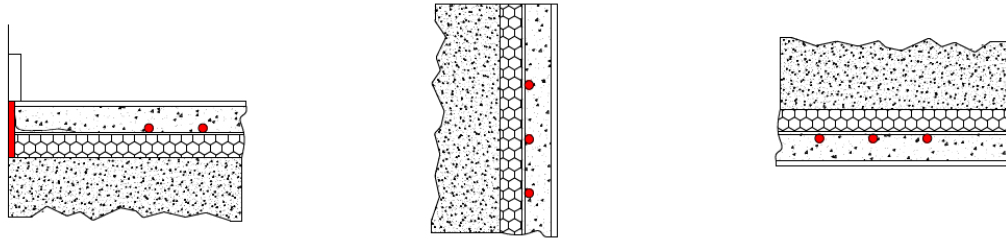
A1. Sistema radiante TIPO A1. Tubería en capa de difusión térmica. Desacoplado térmicamente de la base estructural del edificio mediante aislamiento térmico plano. Pueden aplicarse diferentes sistemas de anclaje para la tubería.
